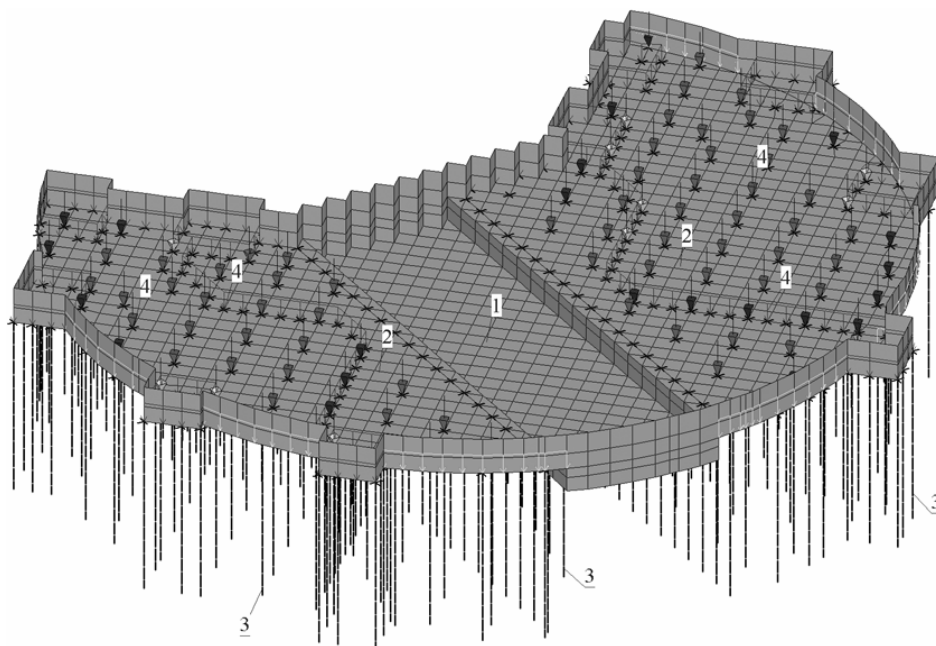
Фрагмент расчетной схемы с конструкциями свайного фундамента за пределами расположения мостового пролета (длина свай составляет 17 м):
